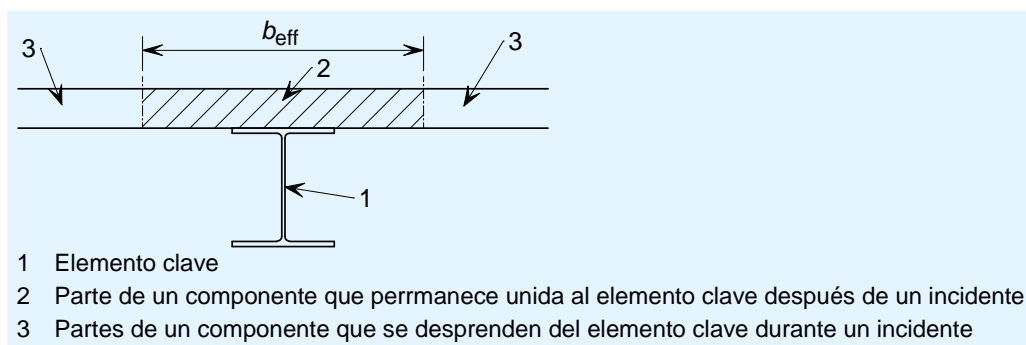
Componente unido al elemento clave (pilar en planta)
